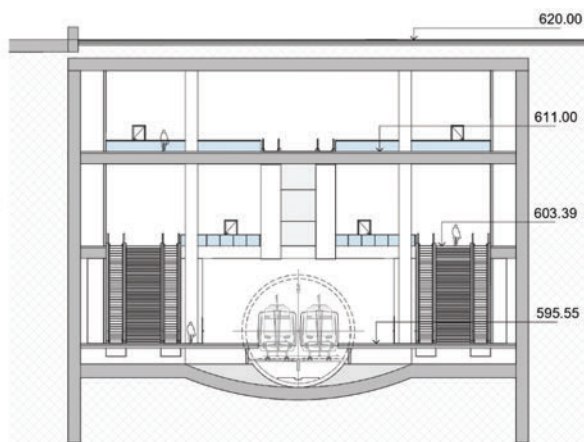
Estación Barajas T4 \_Sección Transversal
